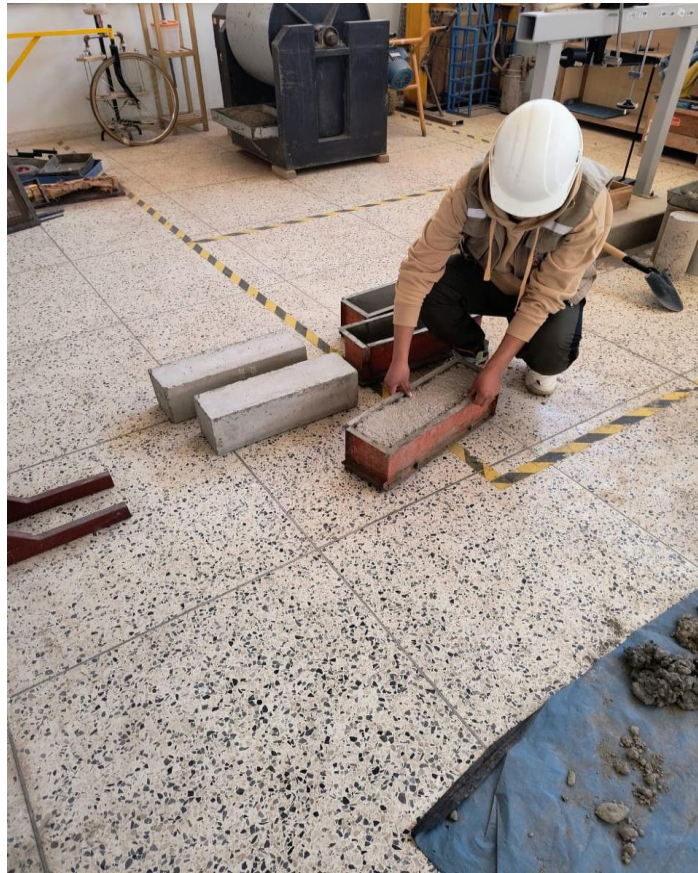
Colocación de las viguetas (resistencia a la flexión)
